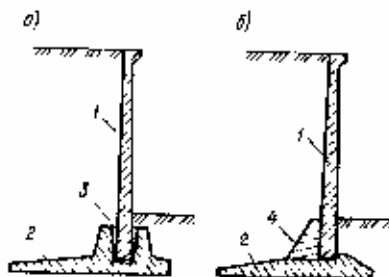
Сопряжение сборных лицевых и фундаментных плит:
